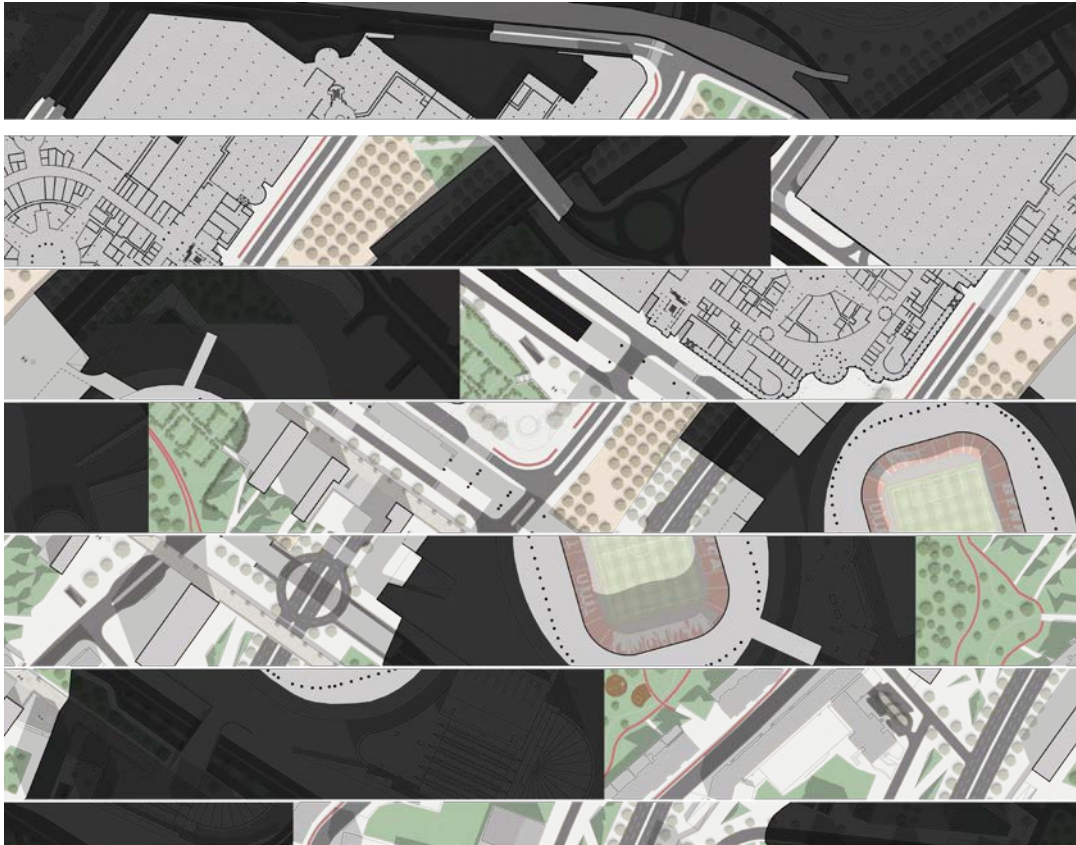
Planta Luz/Colombo cota 86 (Fonte: Autor)
